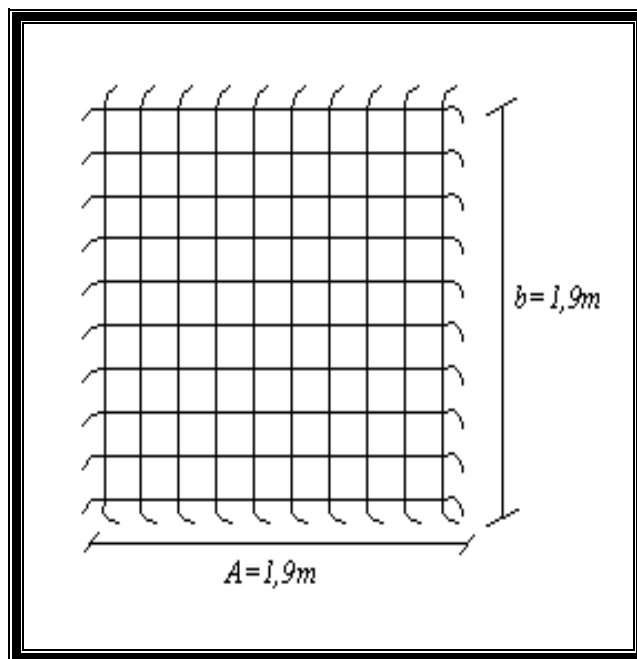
vue en plan de Croqué de ferrailage de la semelle
